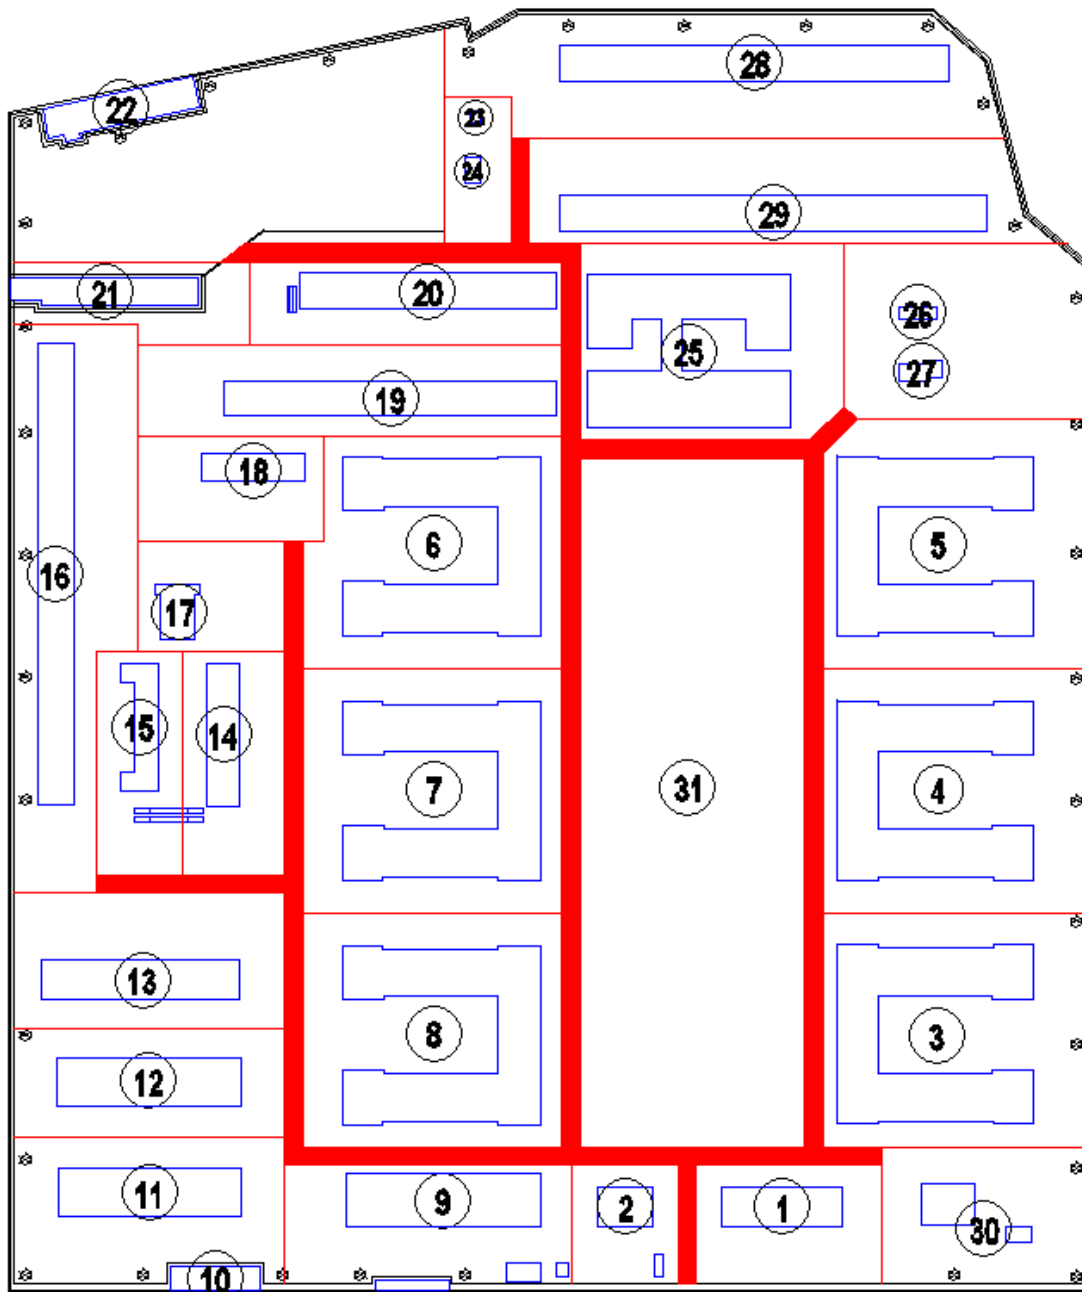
Planimetria della Caserma Cavarzerani suddivisa in lotti funzionali.
